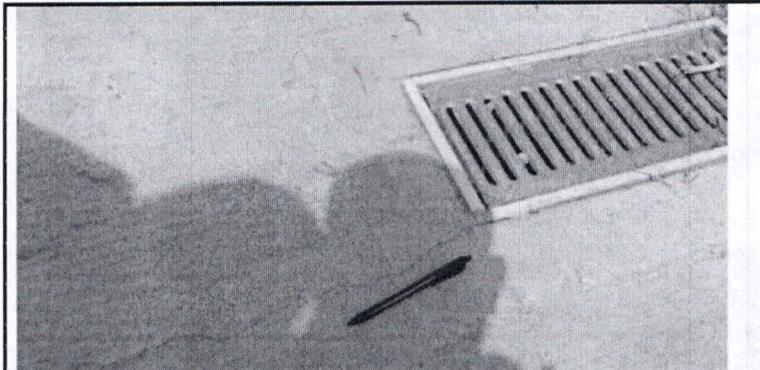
Fisura anden entre Escenario de Patinodromo and futuro complejo de piscinas
